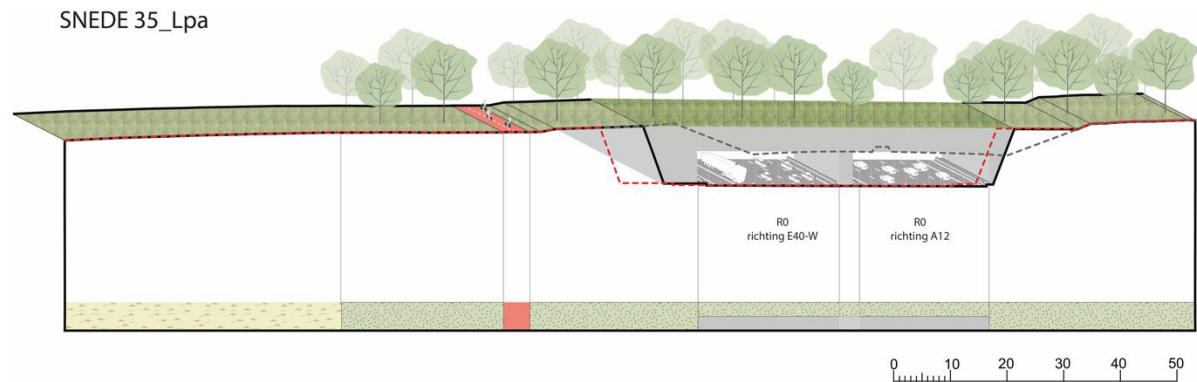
Coupe transversale BB - G1 LPa\_LB\_1
